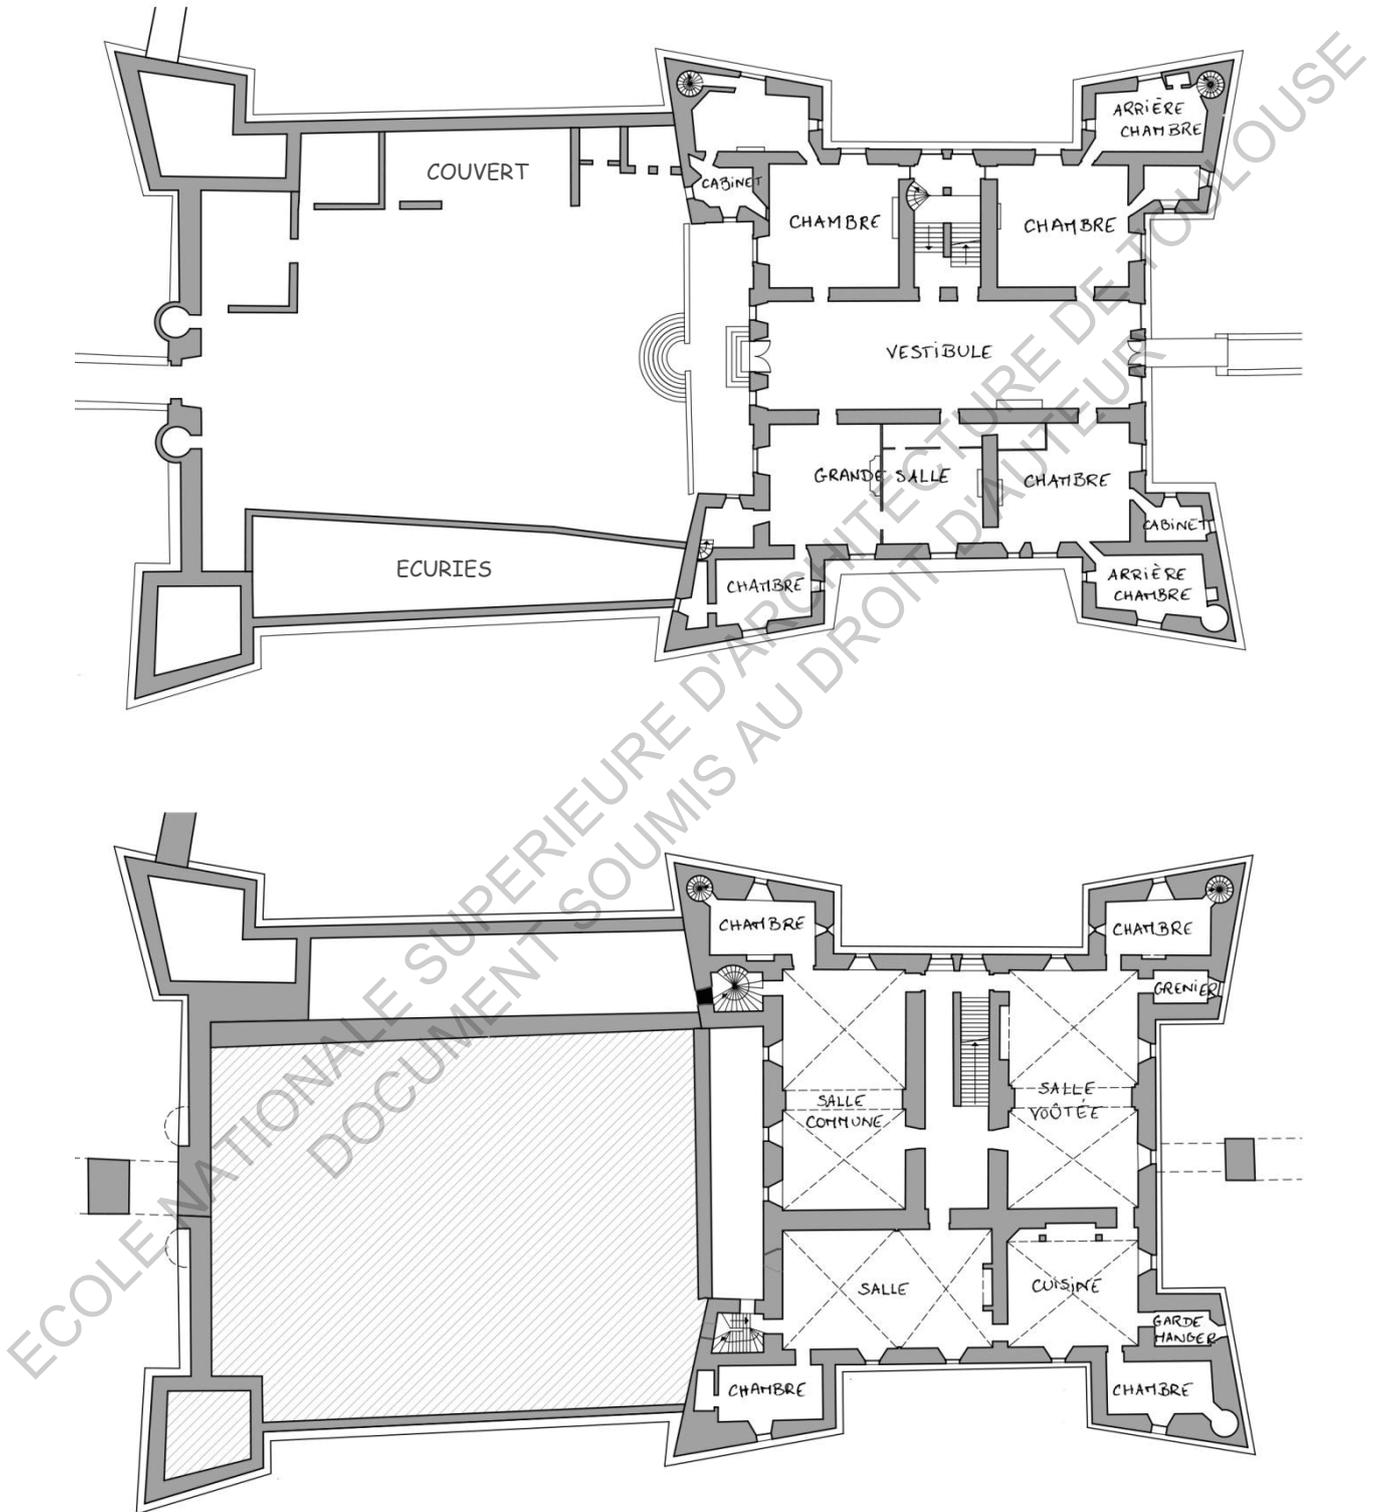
Plan du RDC et R-1 du château de Ferrals, avec destination des pièces.
